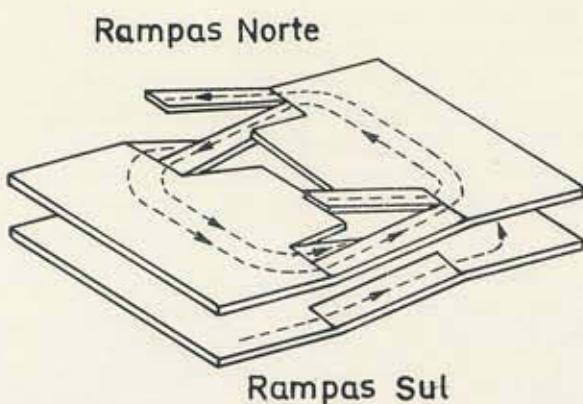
Rampas paralelas separadas entre pisos alternados.
